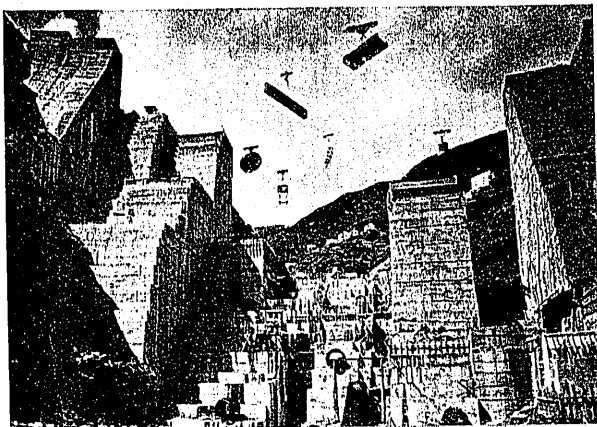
Presa de Salime. Fase de construcción de esta obra. Se utilizaron cinco cables-grúa móviles y dos fijos para trabajos de excavación, hormigonado, etc. Obsérvese que uno de los cables-grúa transporta un panel de encofrado de 30 m.².
